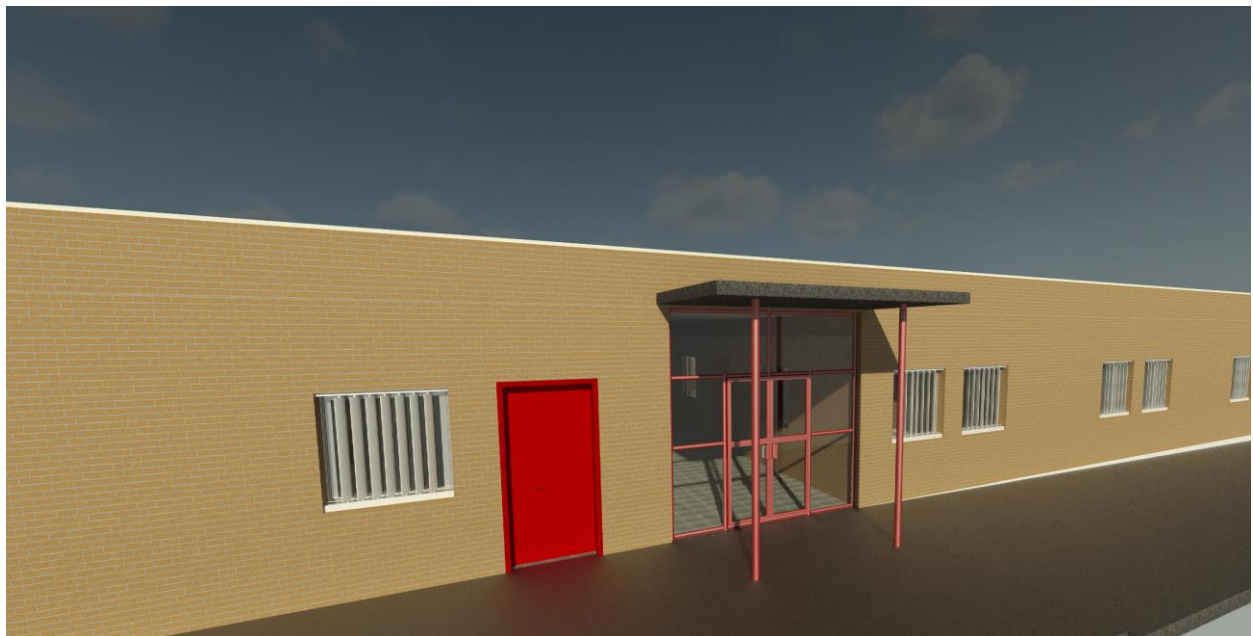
Render con el resultado de la fachada principal y la puerta de entrada al colegio
